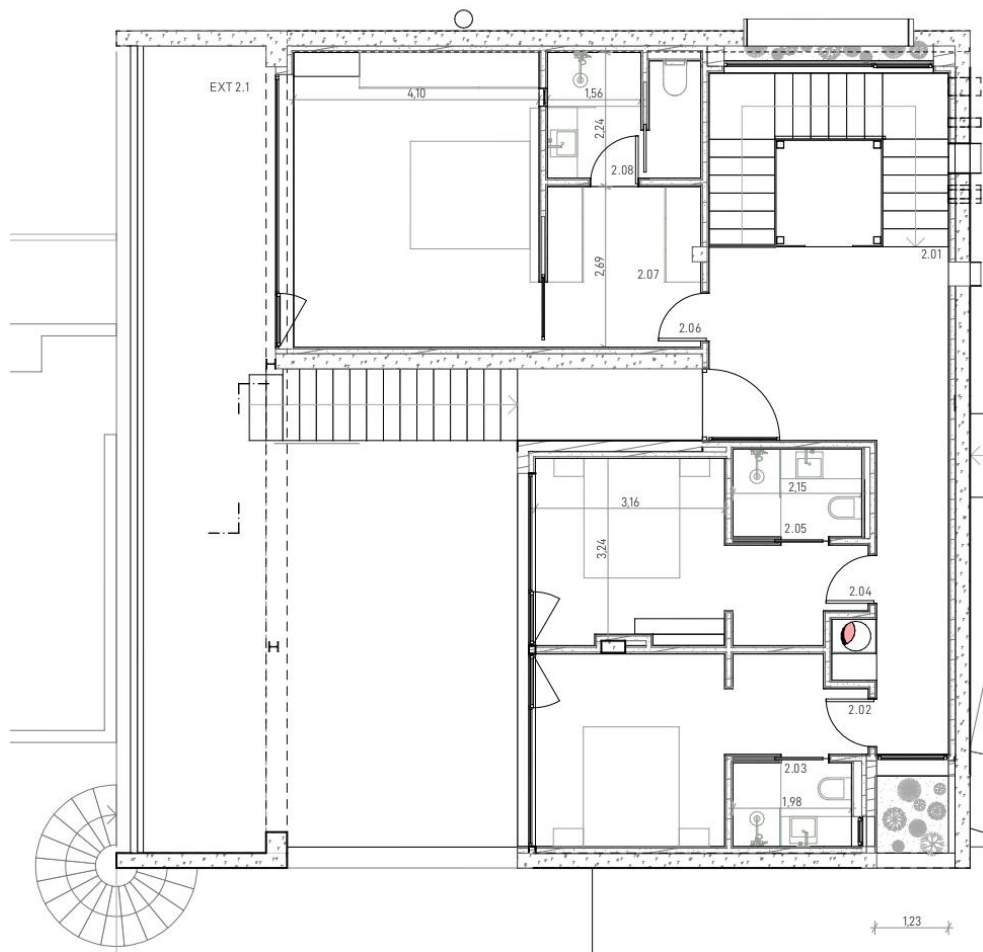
Planta Piso 2, Habitação Água de Madeiros. Fonte. autora.
